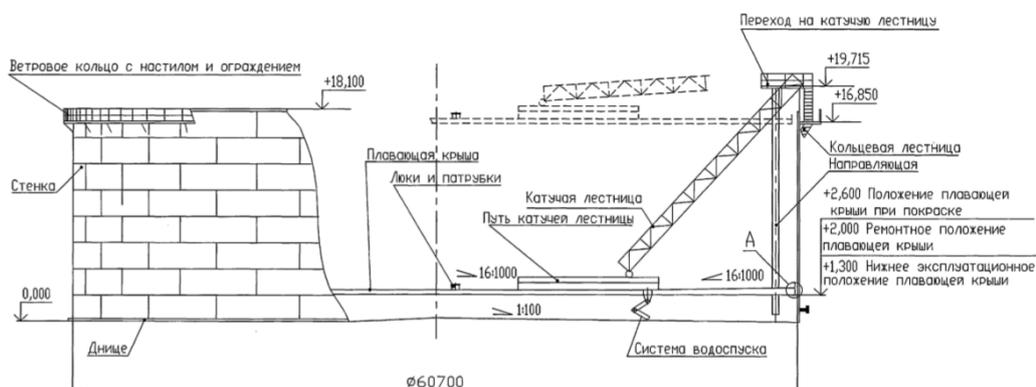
Схема резервуара РВСПК-50000 м³ в разрезе.
